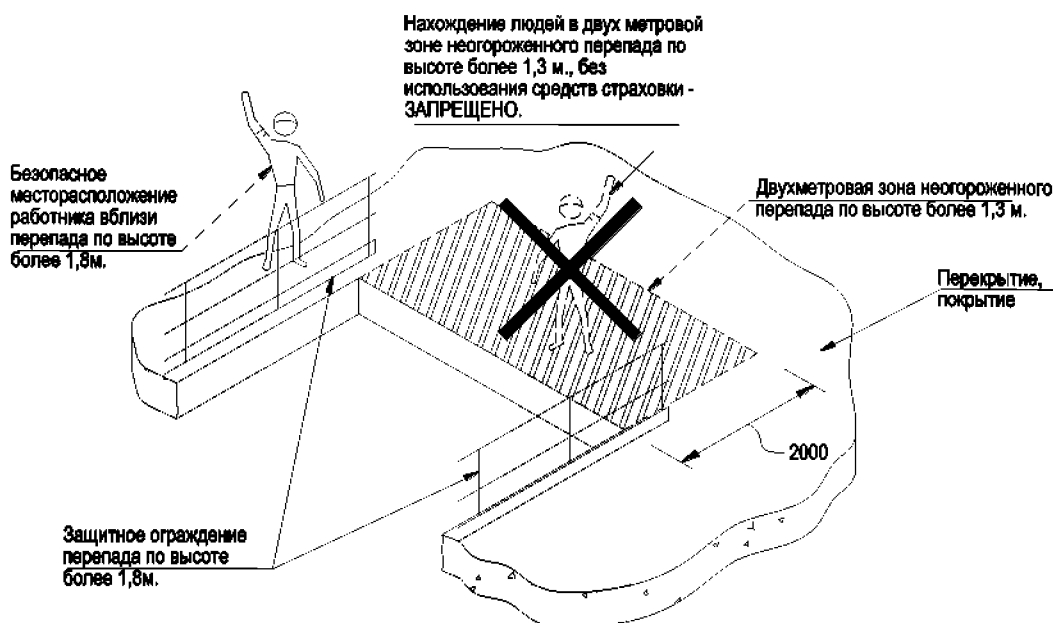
Схемы по безопасному ведению работ в двухметровой зоне неогороженного перепада по высоте более 1,8м.
